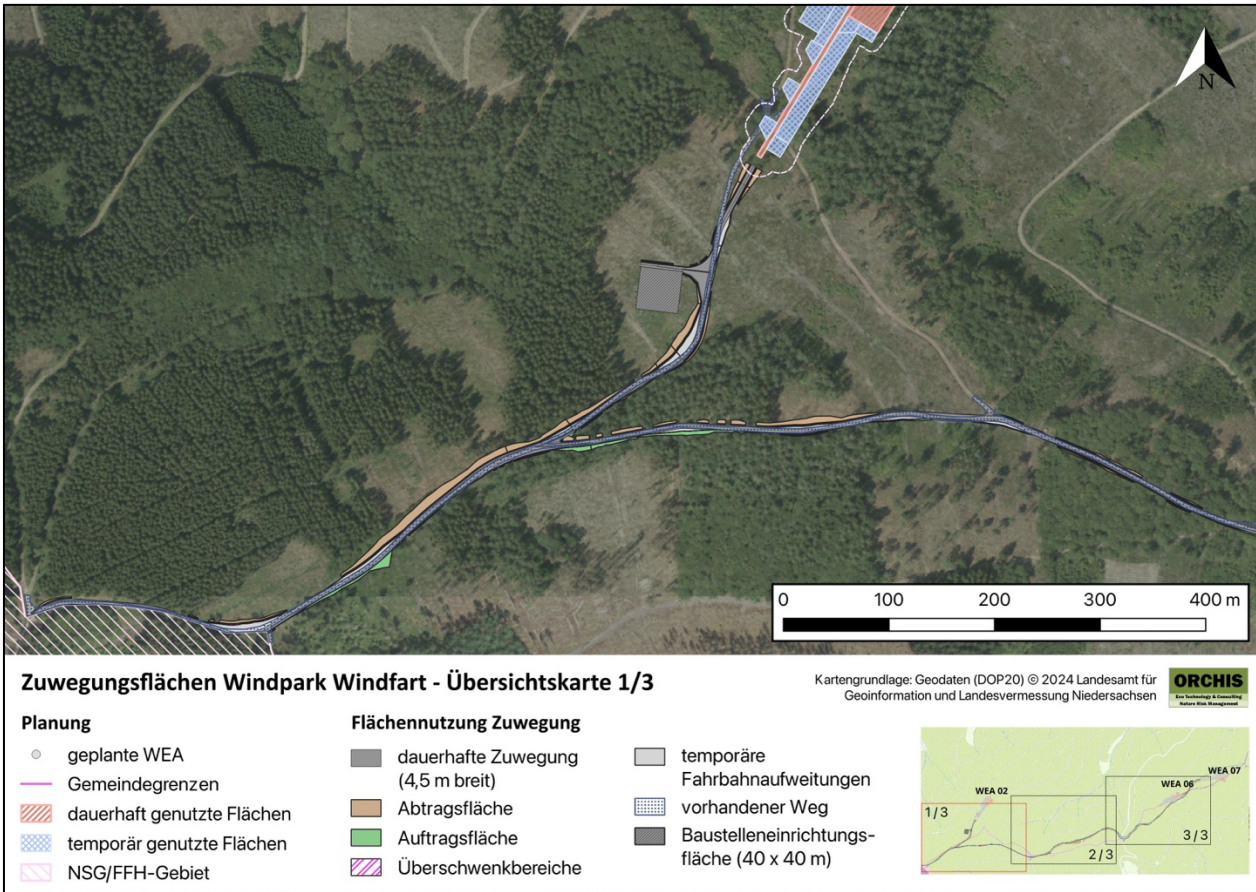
Teilabschnitt 1 des Lageplan zur Flächennutzung für die Zuwegung zur Erschließung der geplanten WEA. Eine Darstellung im A3-Format befindet sich im Anhang.
